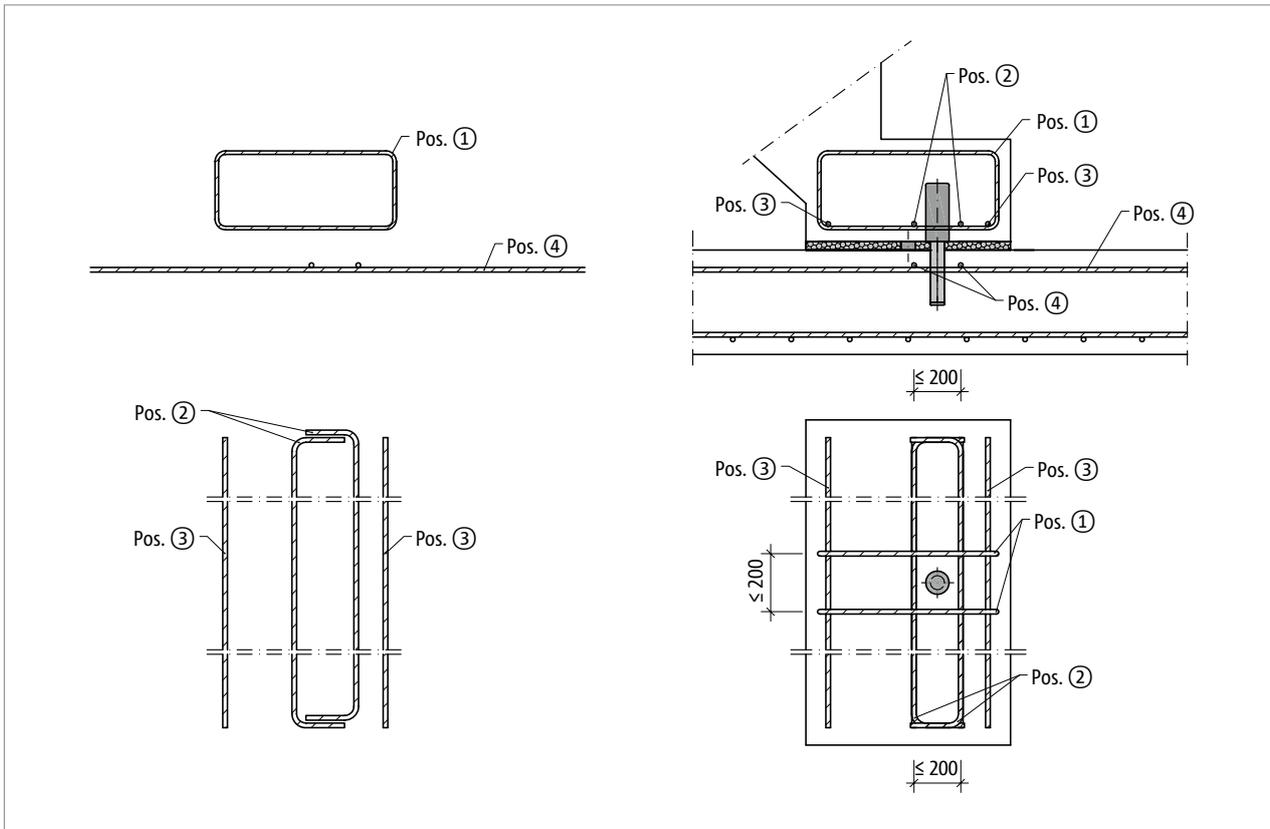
Schöck Tronsole® Typ D: Bauseitige Bewehrung
